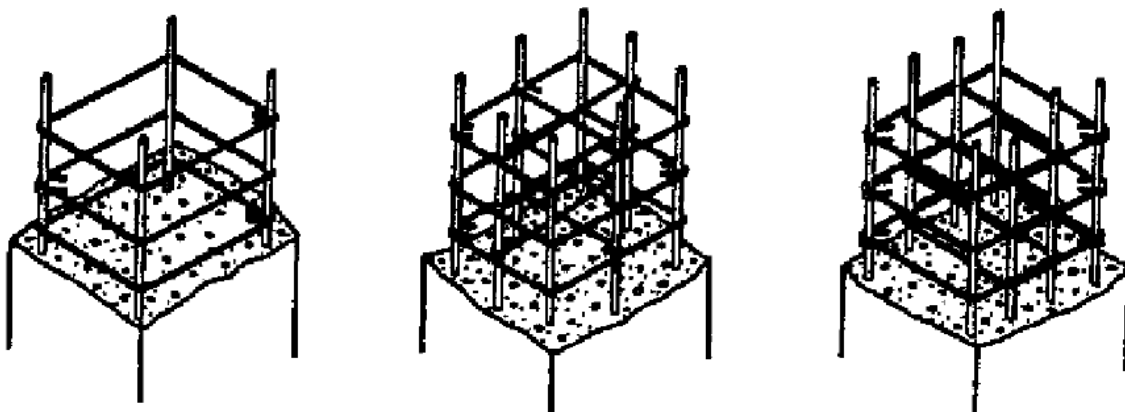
Columnas con estribos y ganchos. (Concreto armado)
